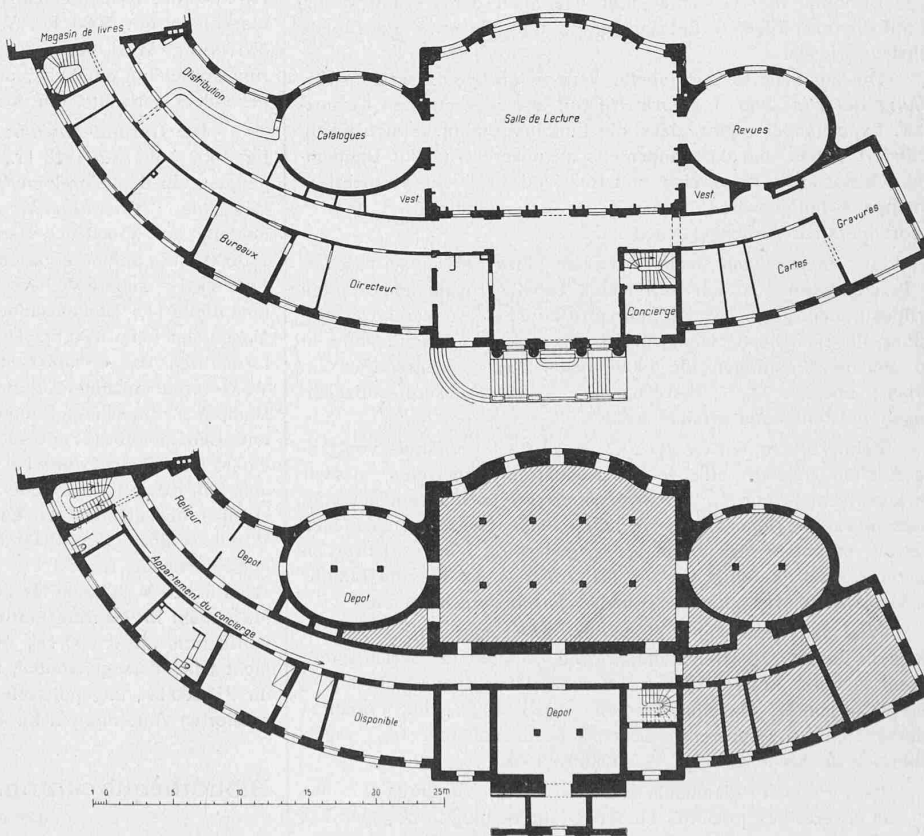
et 3. Plans du Sous-sol et du Rez-de-chaussée. — Echelle 1:500
